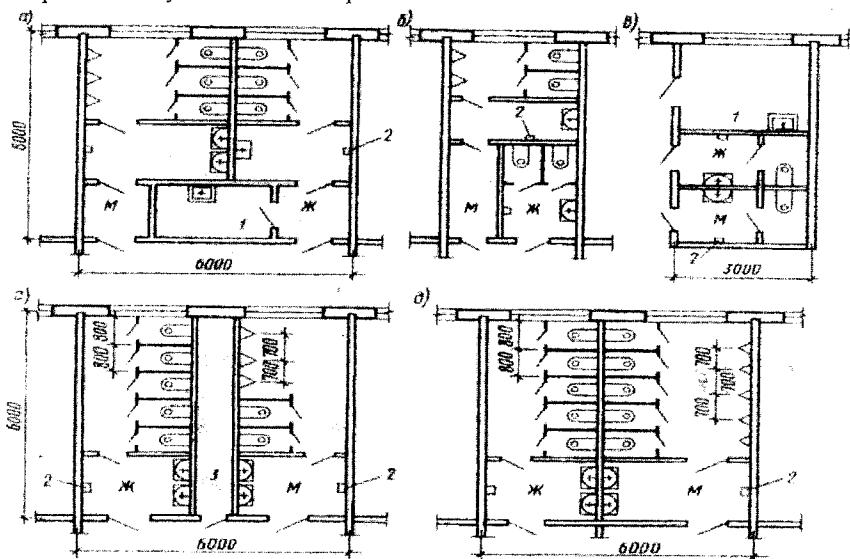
Приклади планувальних рішень санвузлів:
